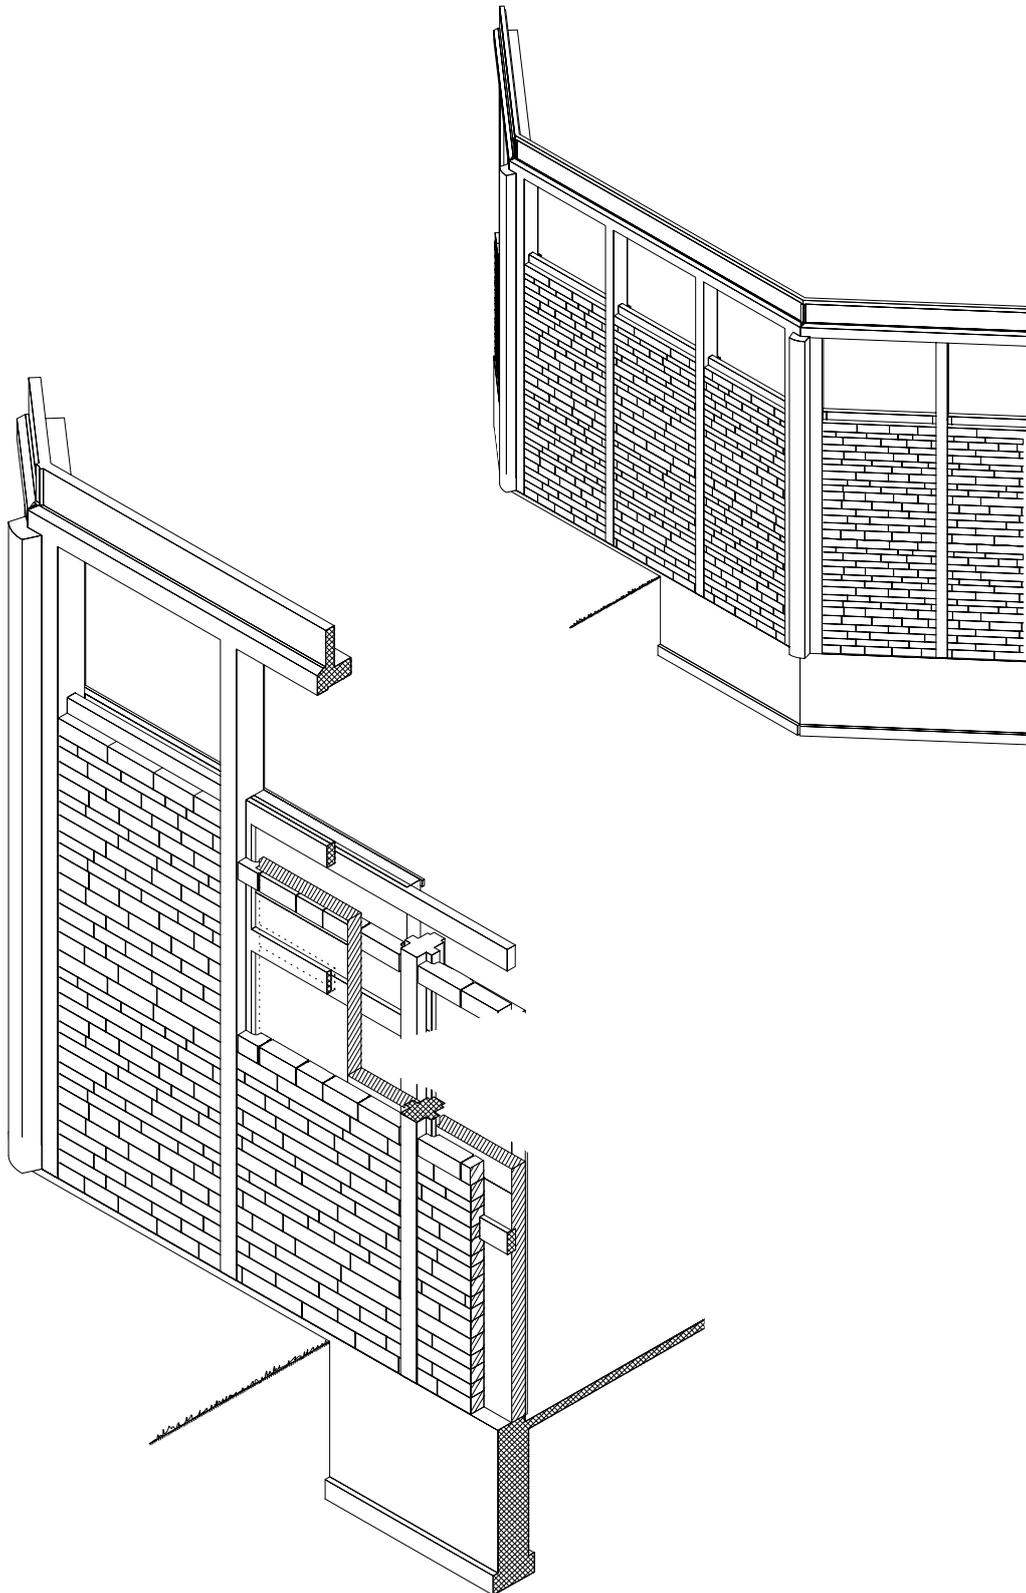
Detail Eisenbetonskelett Querträger und Pfosten
